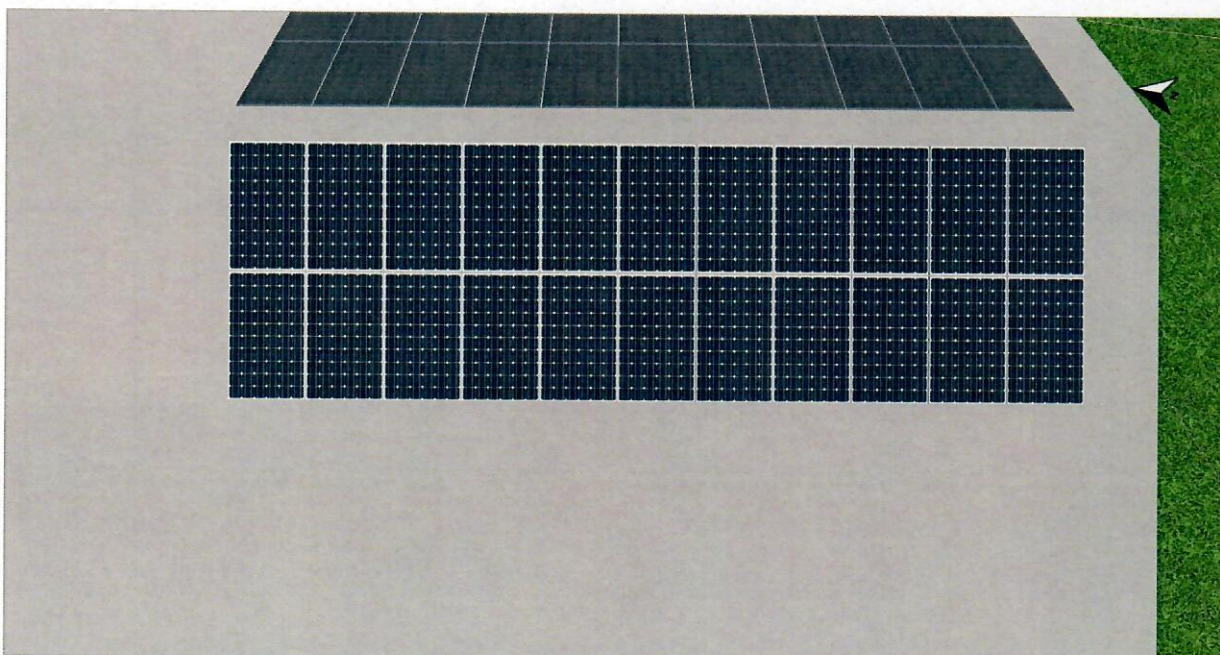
Modulevlak - Building 01-Roof Area East
